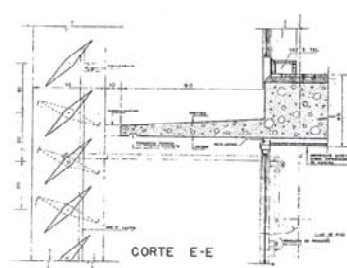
Uso de brises horizontais em edificação na Av. Paulista. Banco Sul Americano S.A., São Paulo, Brasil, projeto de Rino Levi, construído em 1.960/1.963.
